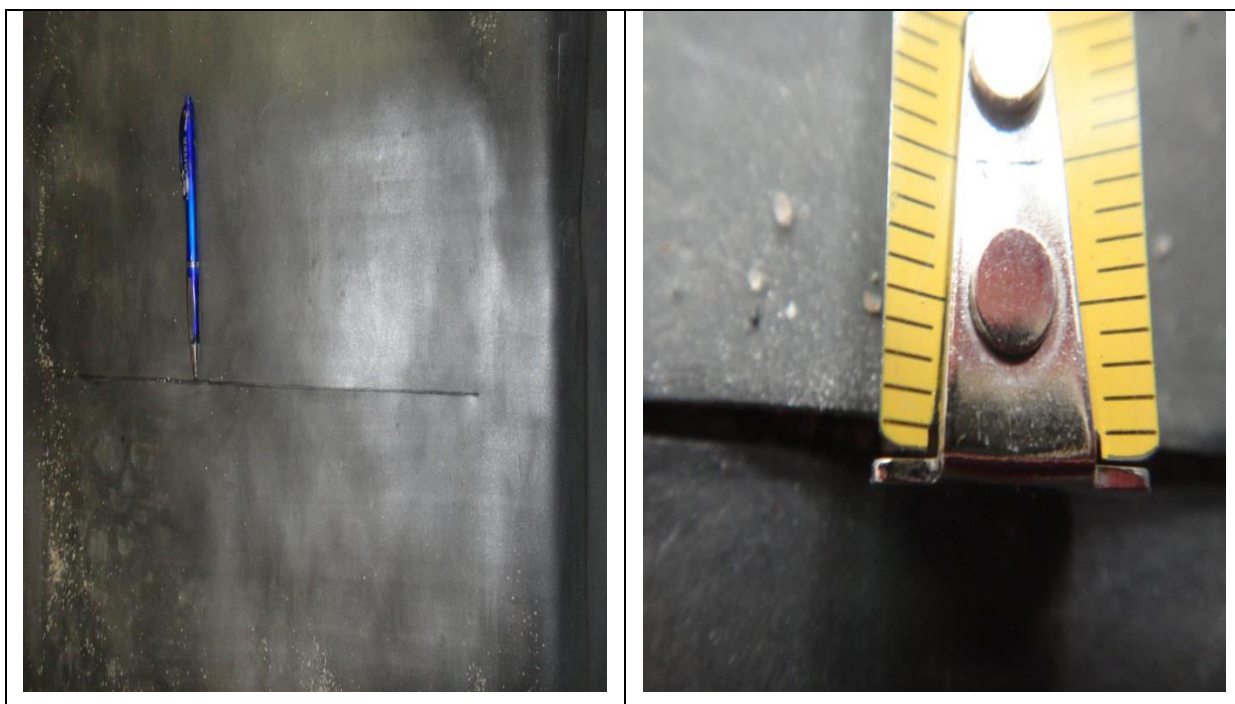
CONSTRUÇÃO DA FISSURA (ABERTURA)
